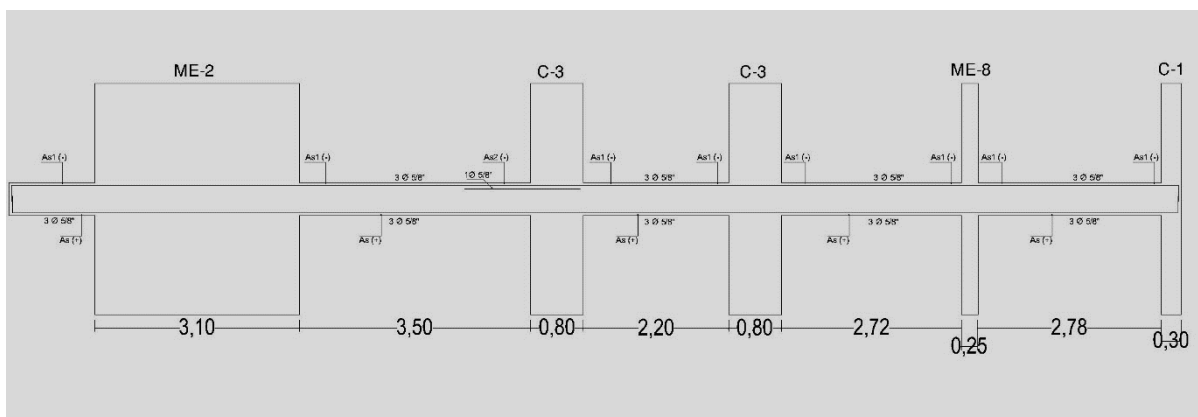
Esquema del refuerzo calculado por flexión para la viga del ejemplo.
